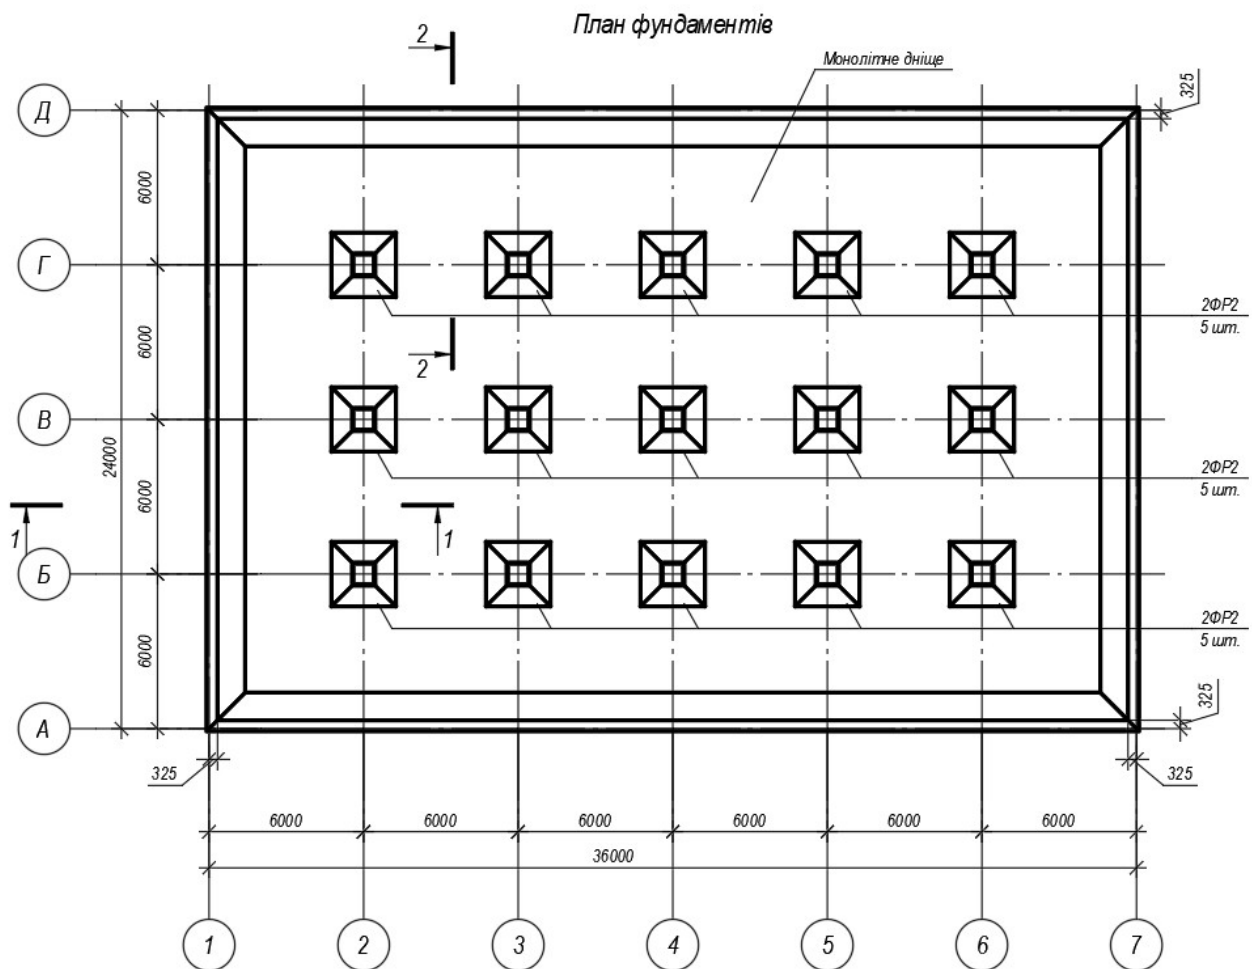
Схематичний план фундаментів РЧВ місткістю 4000 м³
